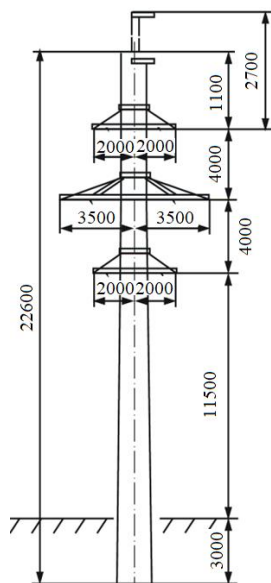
Внешний вид опоры ПБ110-6 [24]
